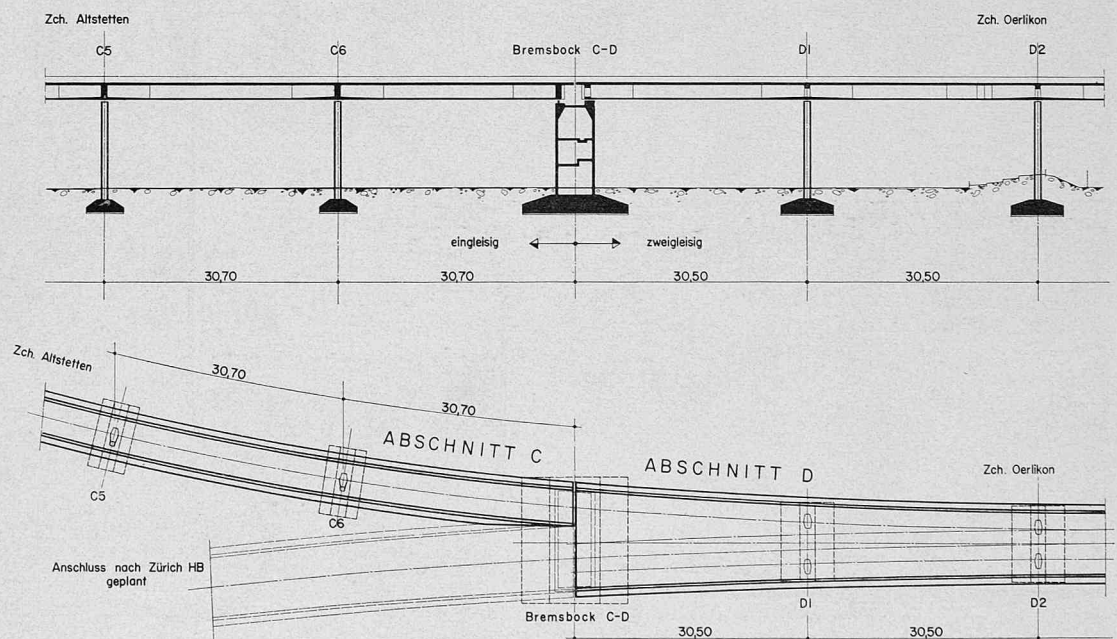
Abzweigstelle Herdern, Grundriss und Längsschnitt 1:1000
